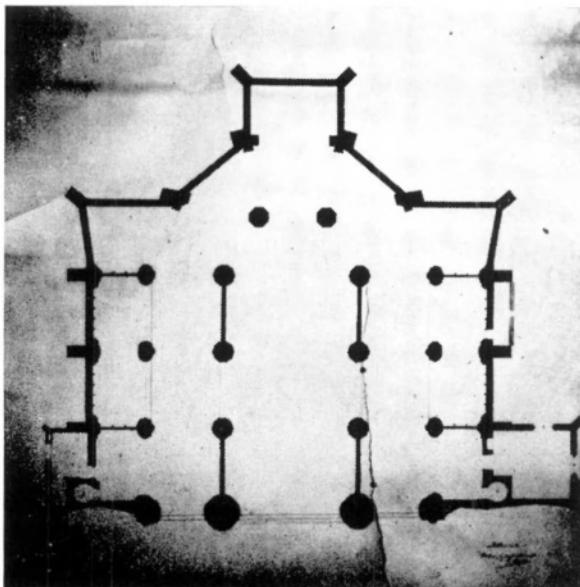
Plan du chœur. Relevé exécuté le 31 juillet 1872 à l'échelle 1/50° par l'architecte De Munter. Archives de l'église, plan n° 2.
